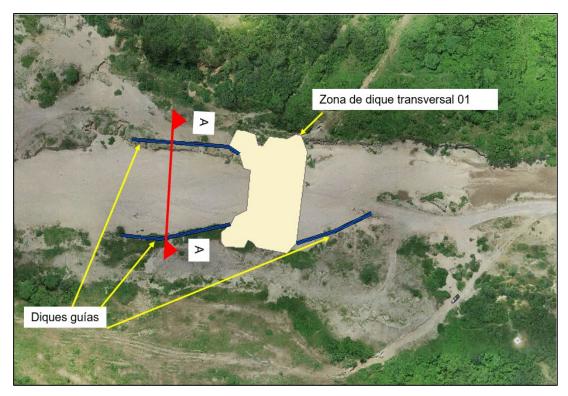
Vista en planta de ubicación de los diques guía propuestos.
